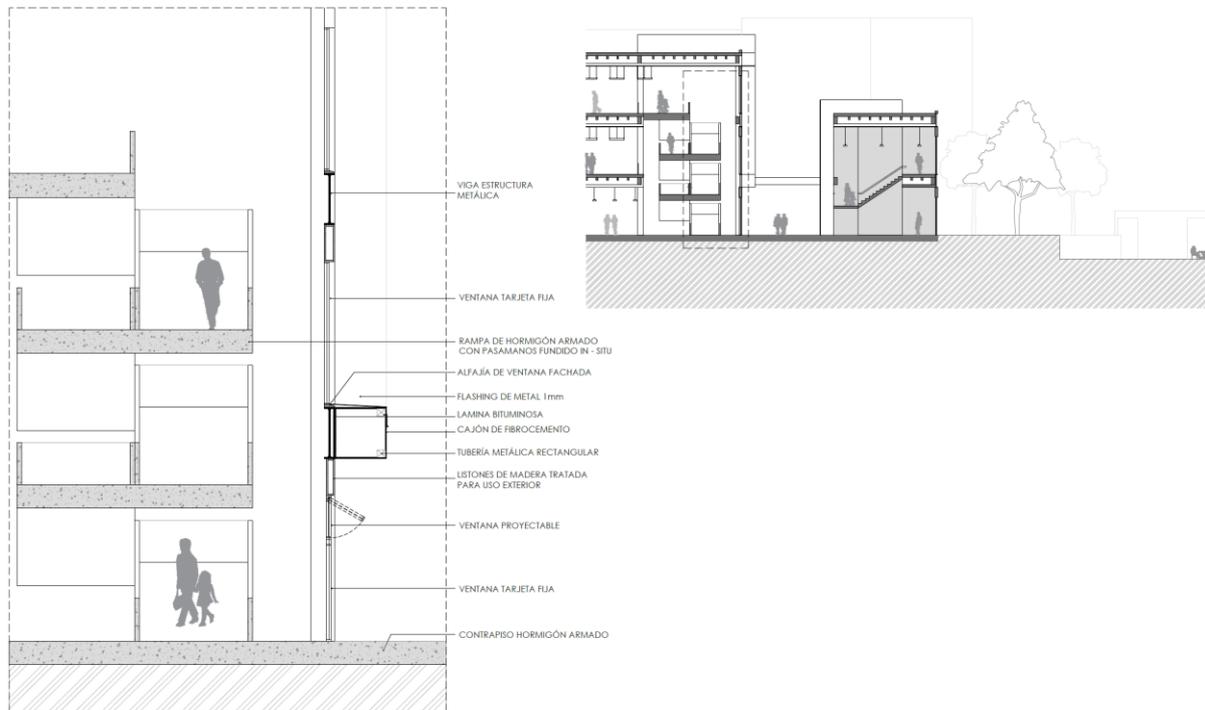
Ampliación - detalle constructivo corte transversal B - B'. Elaboración propia.
